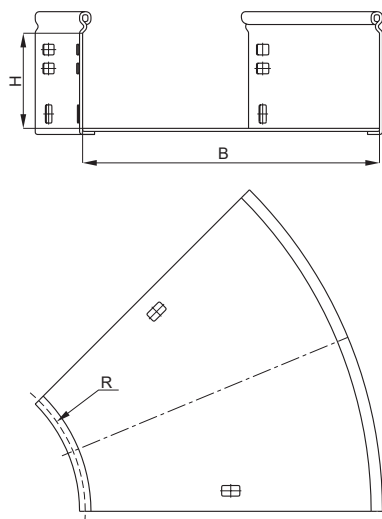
Поворот плавный 45° тип Г01. Размеры для размещения кабеля /
